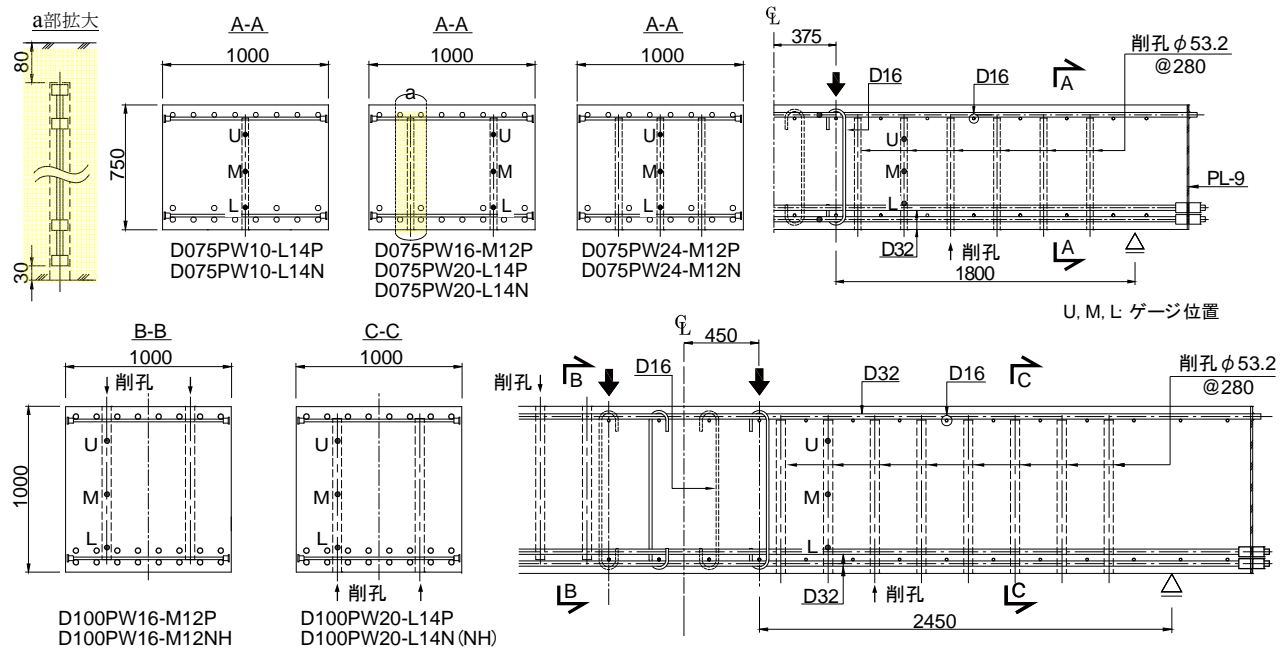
せん断試験体の構造配筋図と加力方法 Detail of Specimens and Loading Point
